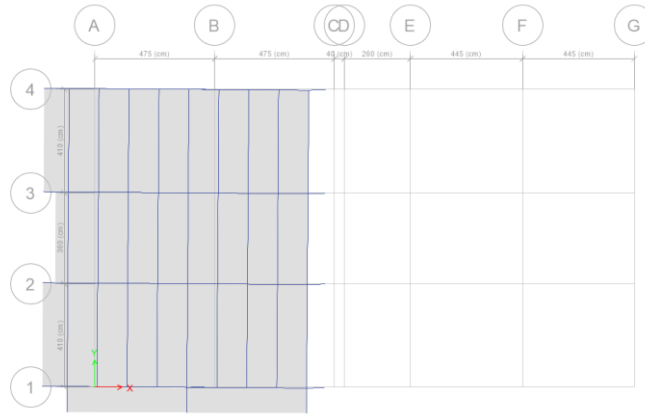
Zona A-Vista en planta primer modo de vibración. Traslación en x (ETABS).
